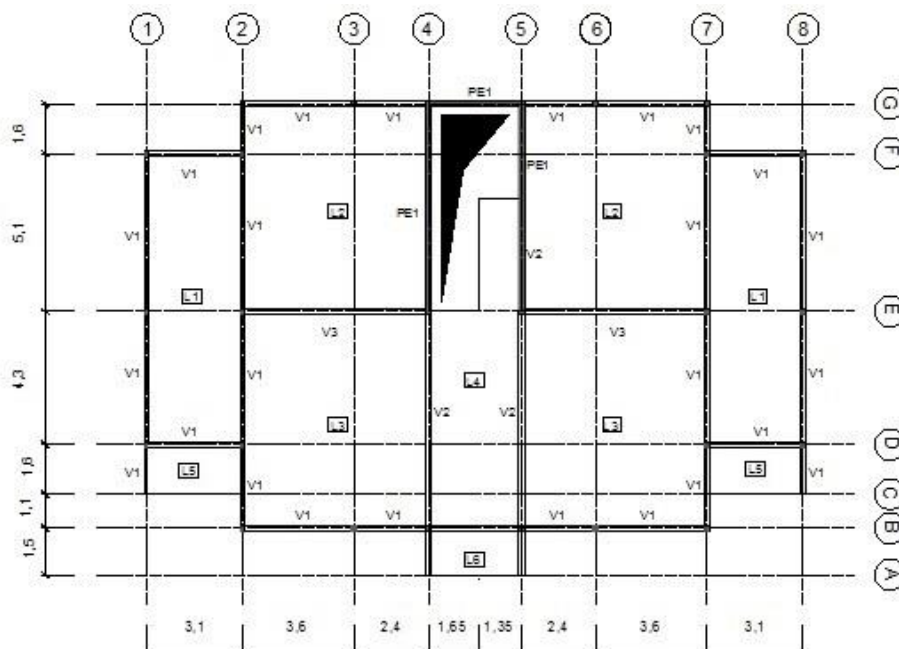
Planta de dimensionamento do caso de estudo 1
